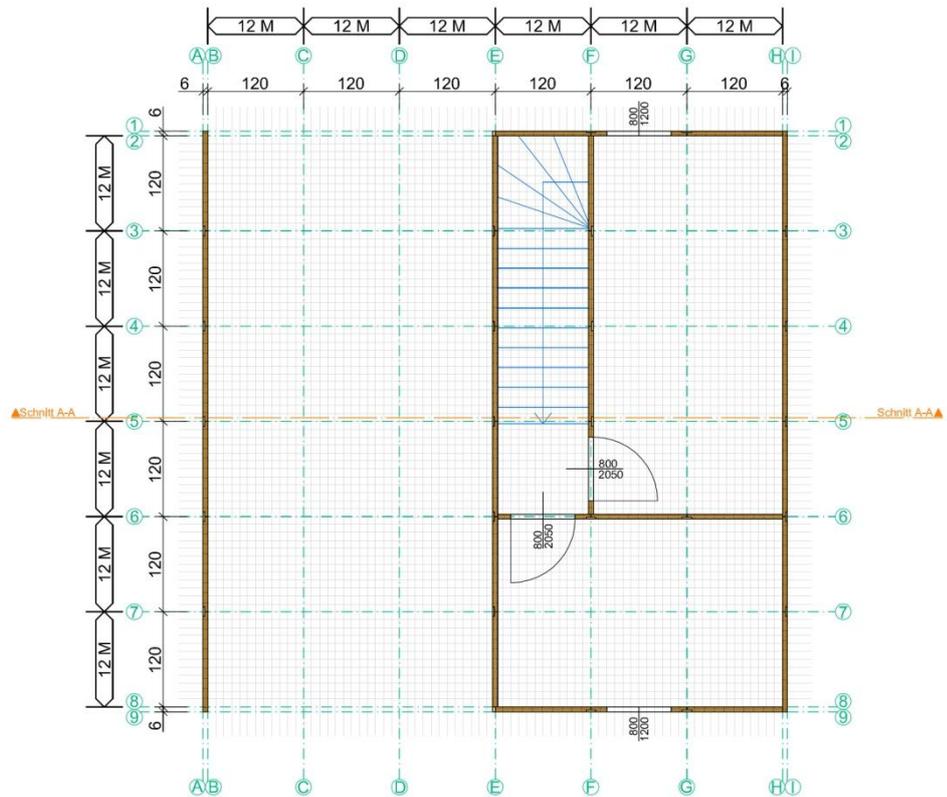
Grundriss des Obergeschosses in der Grundstufe
